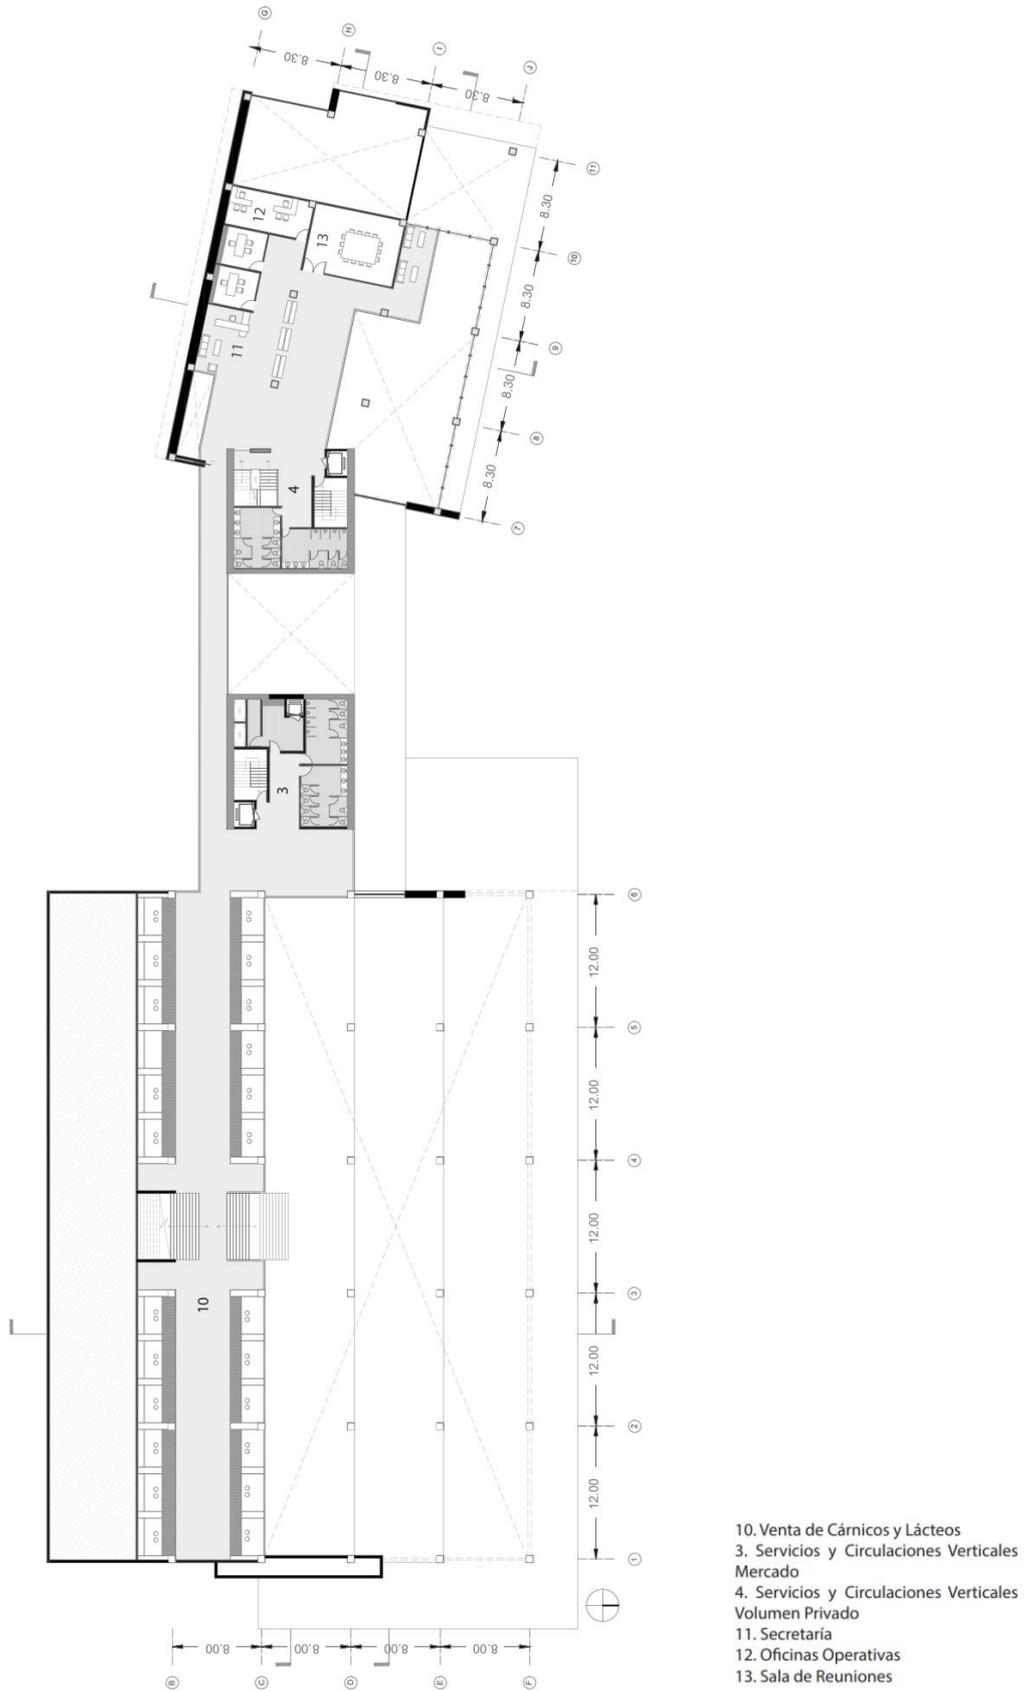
Elaboración Propia. Indicador: Planta Subsuelo Primera N.- 3.30m.
